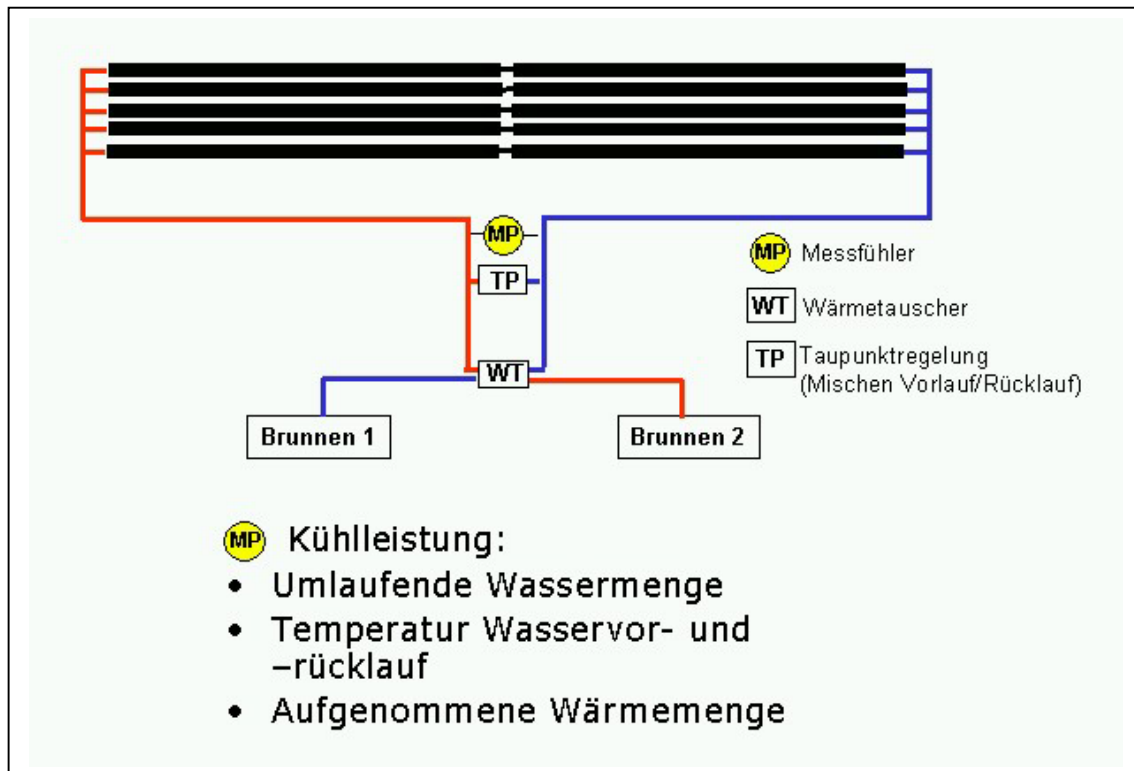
Schemazeichnung der Kühldecke mit Steuerung, Wasserzufuhr und Wasserableitung
